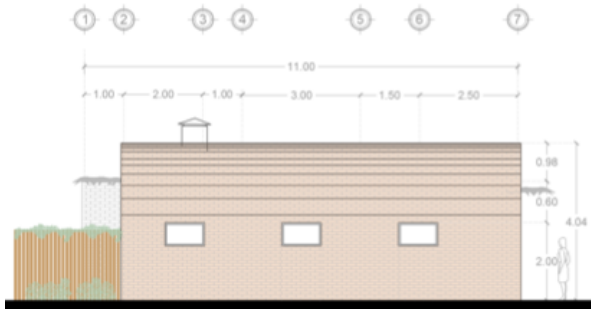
Fachada oeste de vivienda. NOTA: elaboración propia.
